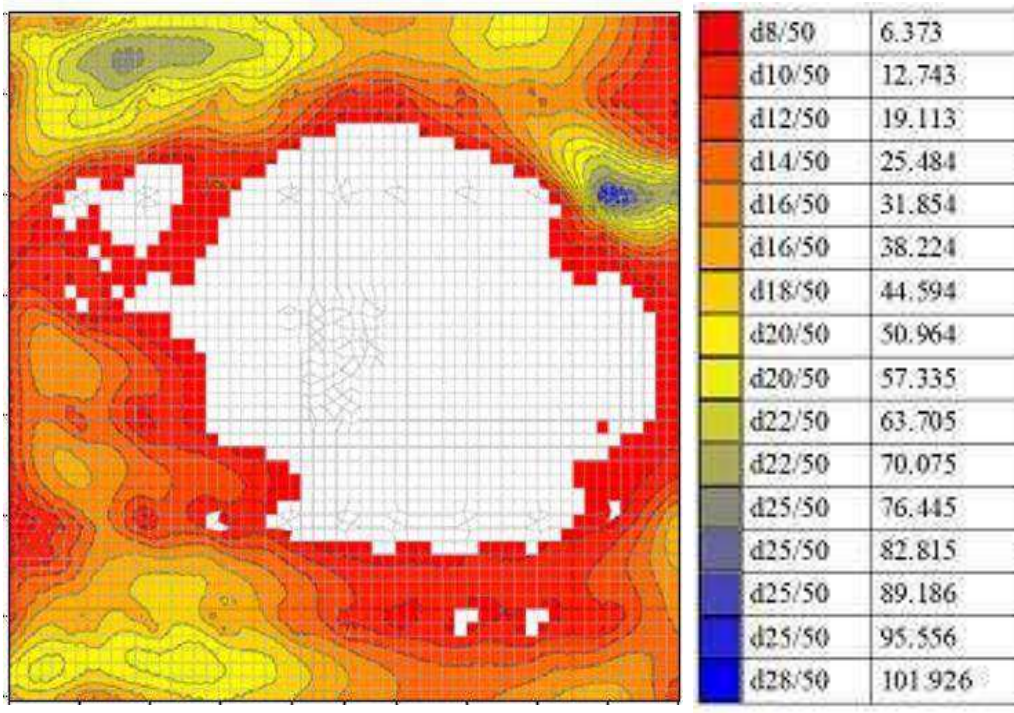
Эпюра верхнего армирования фундаментной плиты, интенсивность S_2
